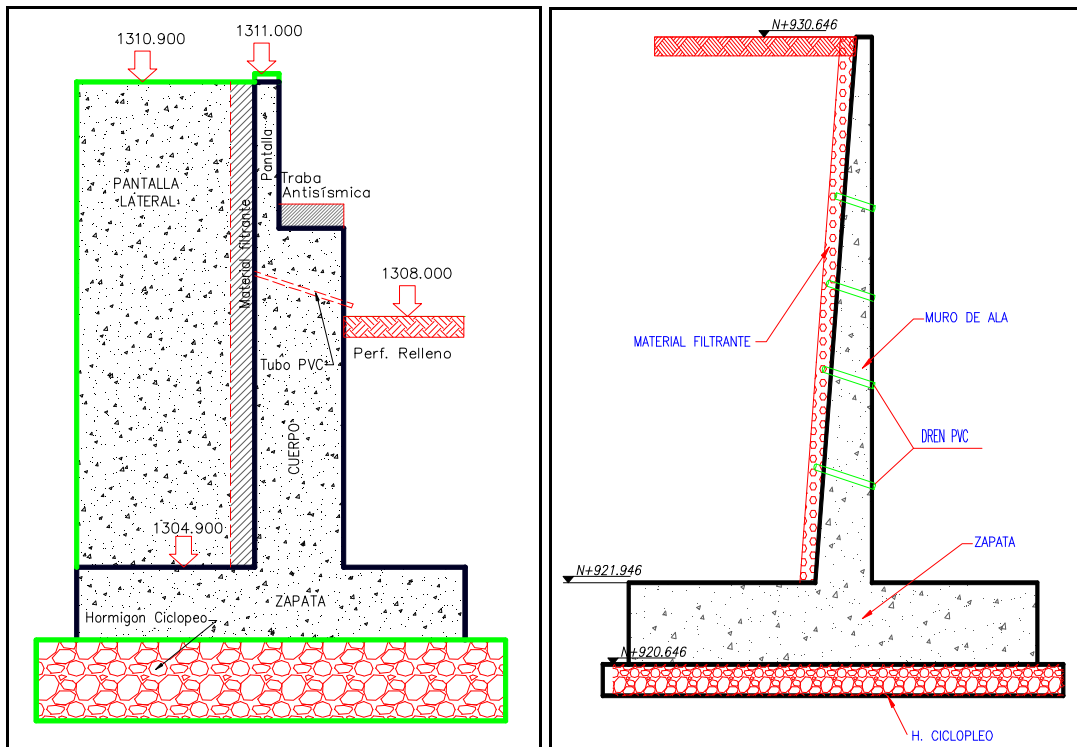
Elevación lateral del estribo - Geometría de muro de ala. Puente Loco.
